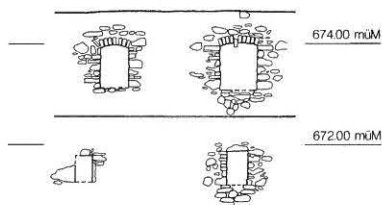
Längenbühl, Hattigen. Ausschnitt Nordansicht der Nord-mauer mit Fenstern, teilweise steingerecht, mit Schnitten. M. 1:100.
